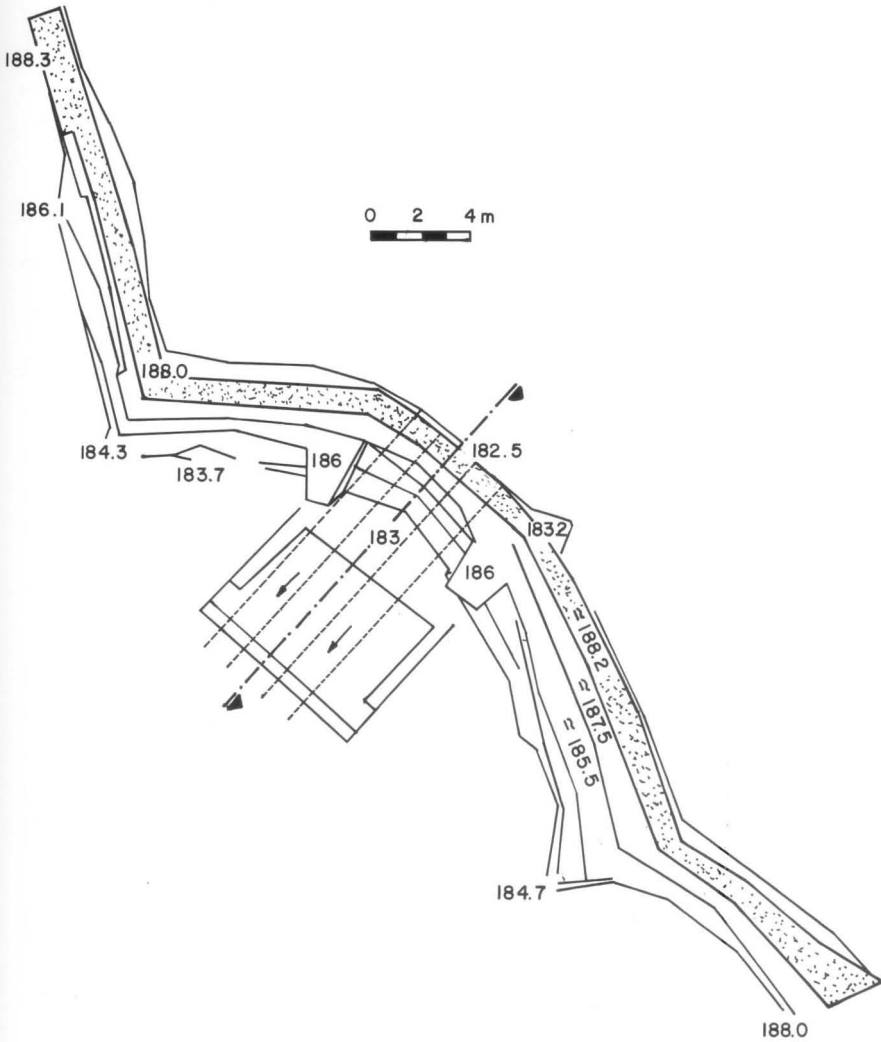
Monte Novo (Évora). Planta y secciones (según el levantamiento de la DGRAH de 1981).
